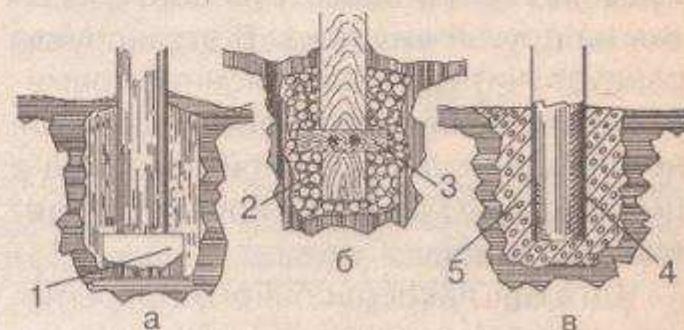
Способы крепления опорных столбов для изгороди: а — в твердом грунте; б, в — в мягком грунте; 1 — камень; 2 — мелкие камни; 3 — перекладина; 4 — битум или деготь; 5 — бетон
